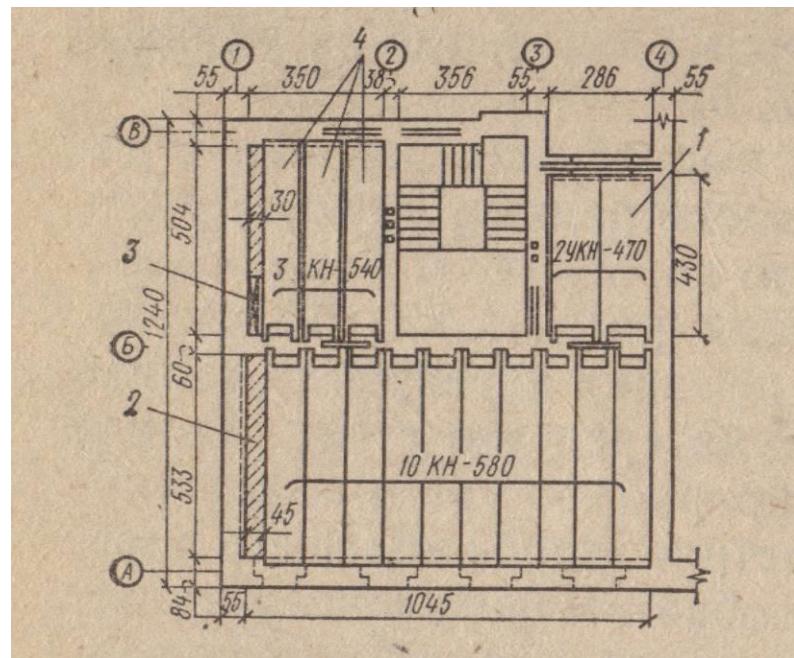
План участка перекрытия из железобетонных двухпустотных настилов с выпускными ребрами: 1 – укороченные трехпустотные настилы; 2 – железобетонная заделка; 3 – вентиляционный блок; 4 – первая захватка.
